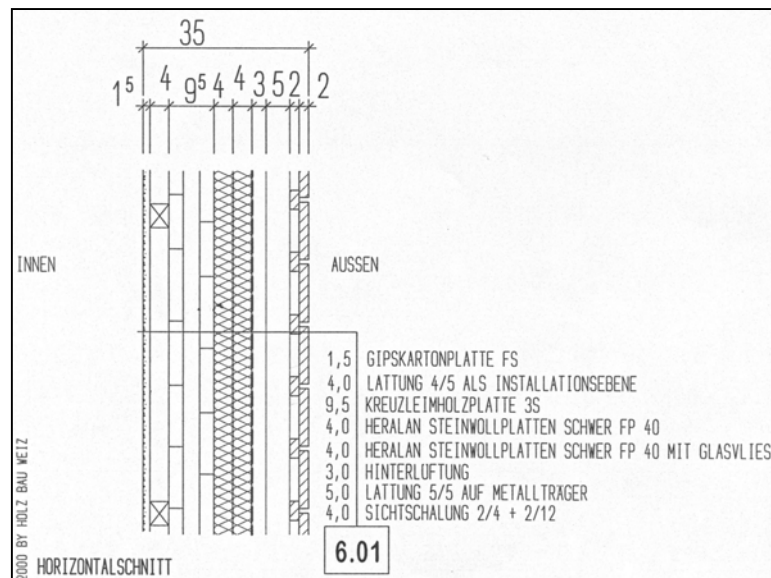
Außenwandaufbau mit einer dreischichtigen BSP-Platte
